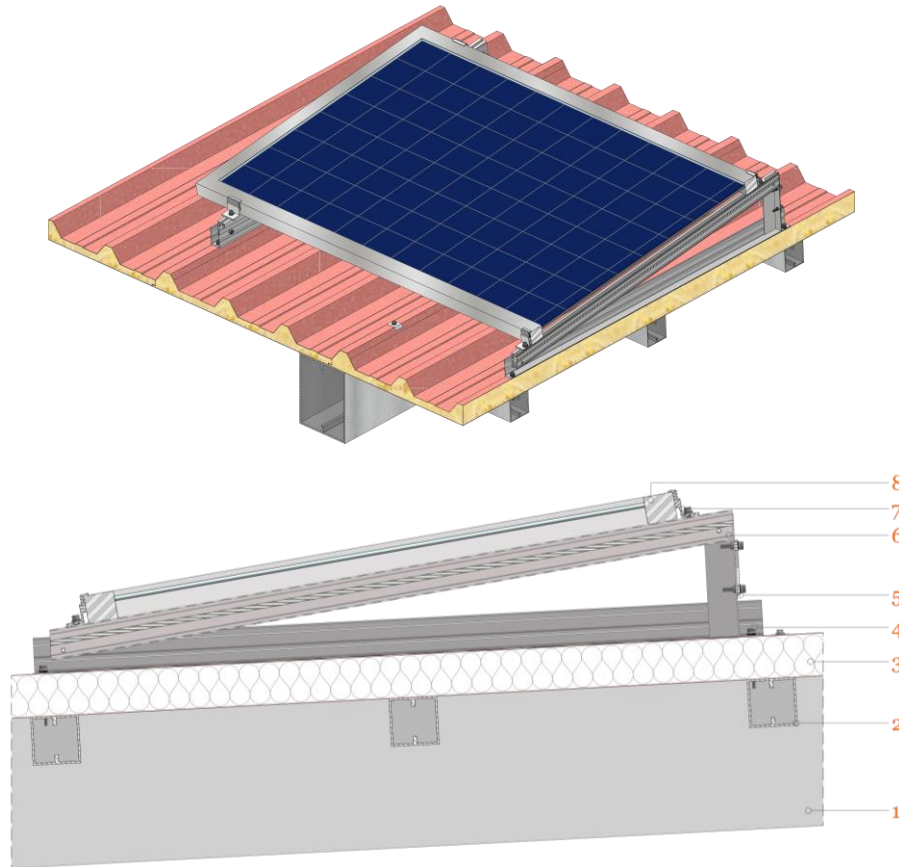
Detalles constructivos en 3D y 2D de sistema inclinado cerrado
